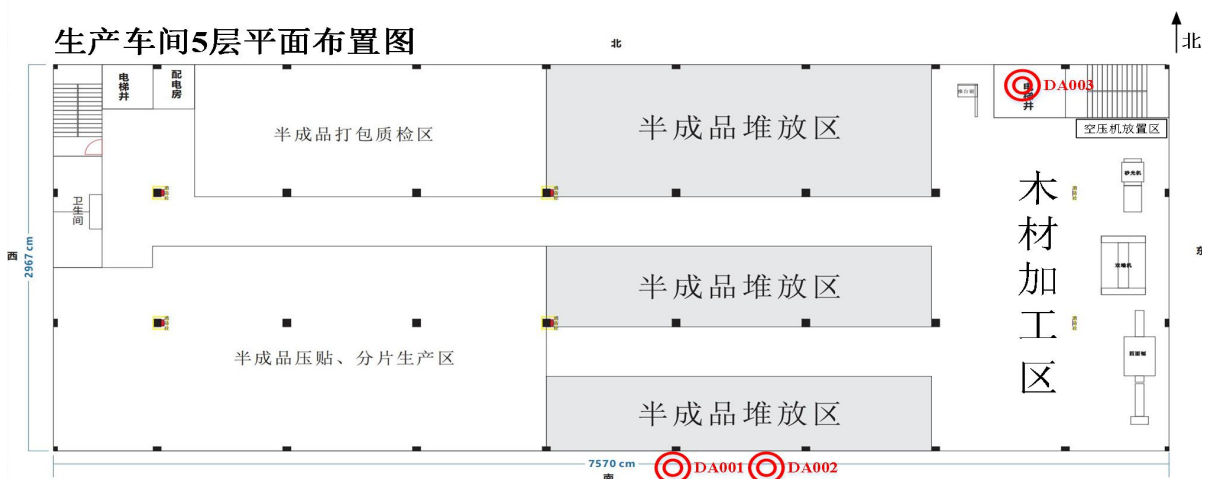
建设项目环评审批生产车间 5 层平面布置图
